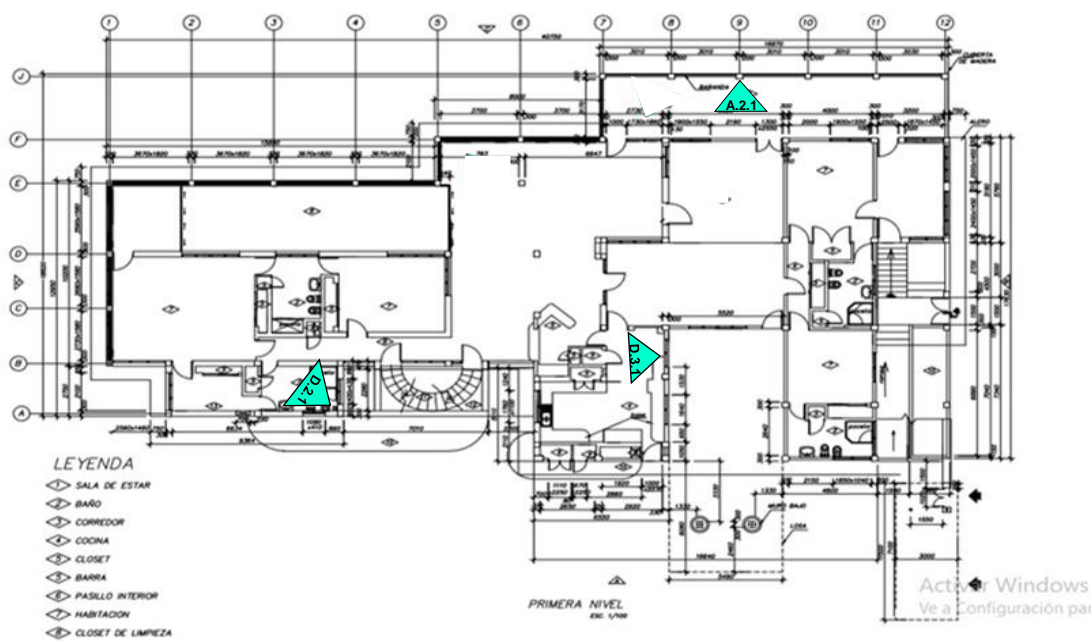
Lesiones ubicadas en planta primer nivel.
